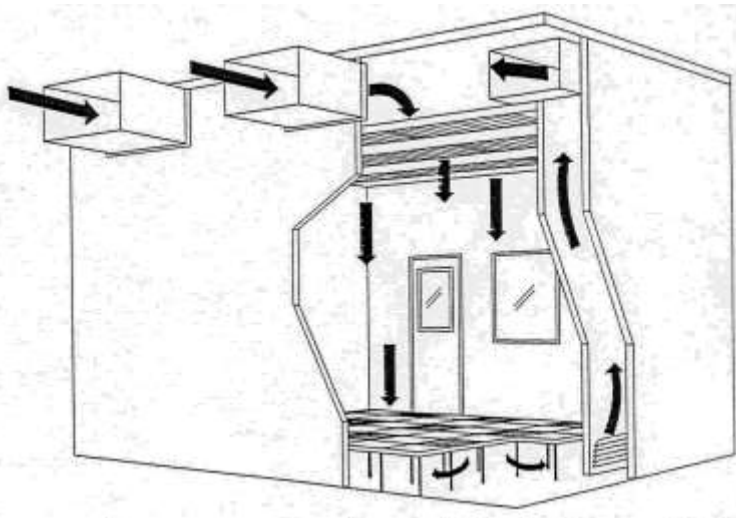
Flusso laminare dal soffitto e ripresa dal pavimento
